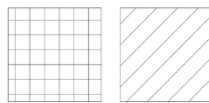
Tramas de pavimento e cobertura, respetivamente [20]
